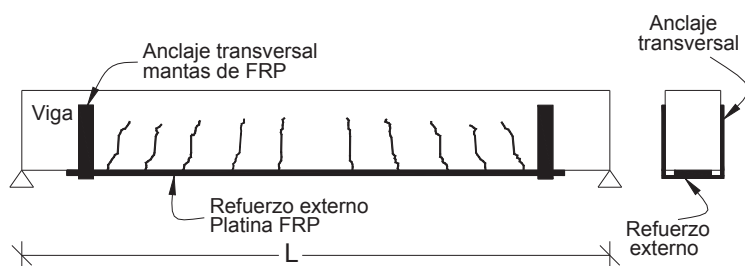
Anclaje transversal para el incremento del anclaje en los extremos de la platina FRP en una viga reforzada.
